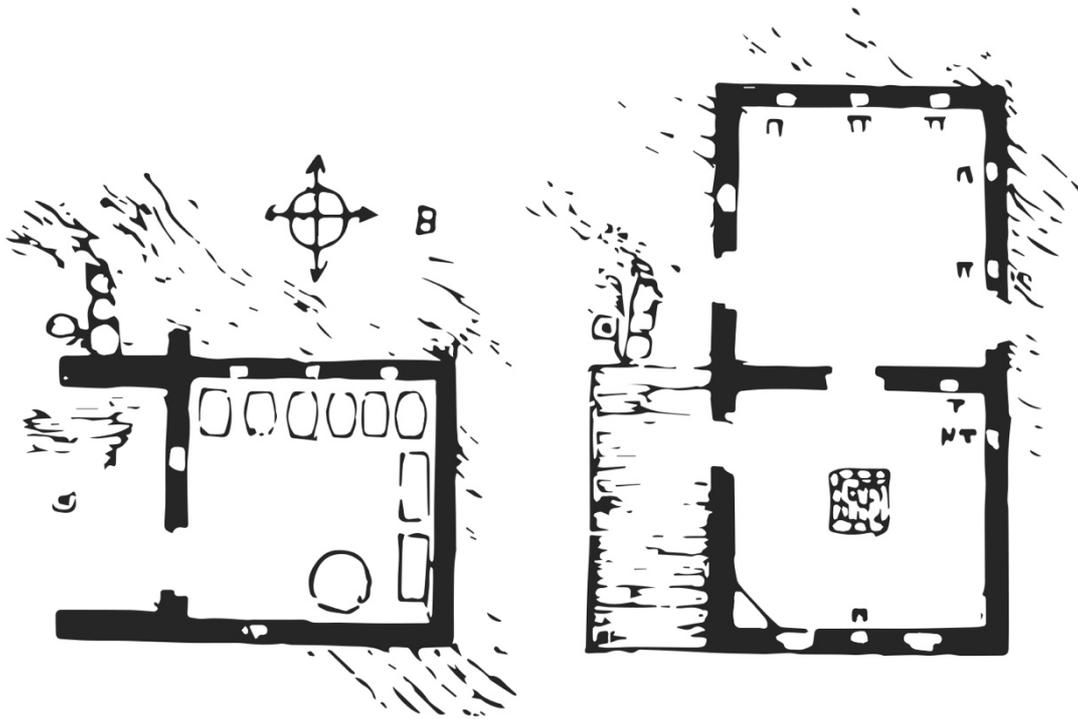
h: Grundriss eines Einfamilienhauses nach dem Bautyp sterfogalaro. Links: EG, Rechts: OG
